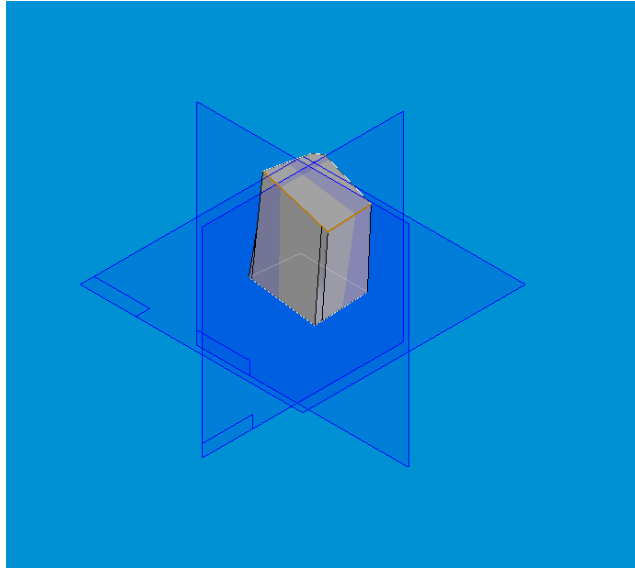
Ricostruzione geometrica del pilastro 27.
